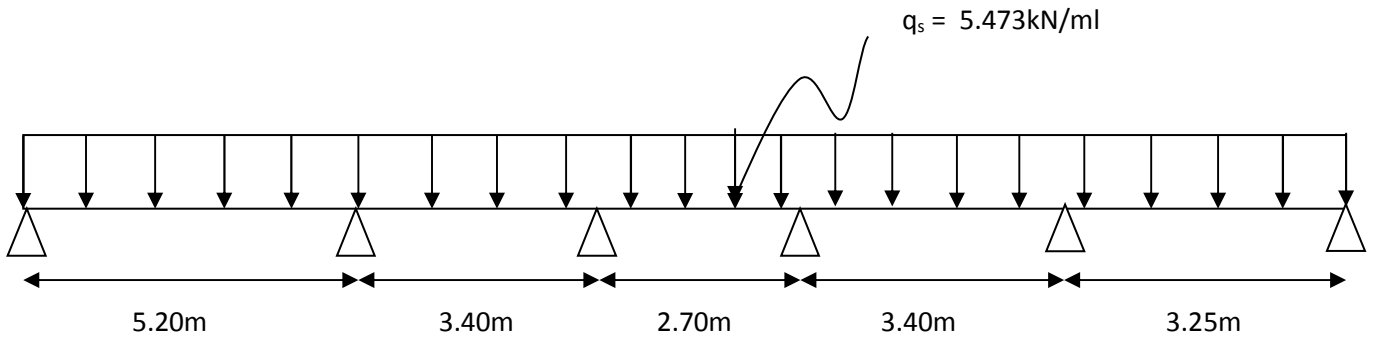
Schéma statique de la poutrelle type 1 (terrasse).
